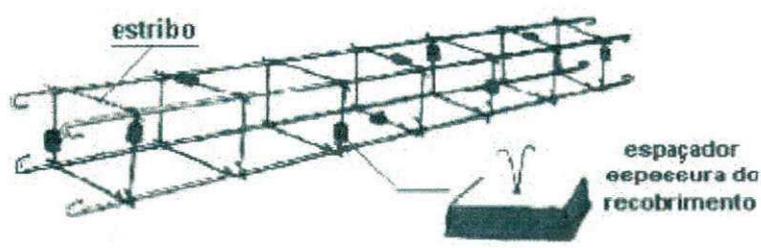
Montagem da ferragem dos pilares do poço do elevador
